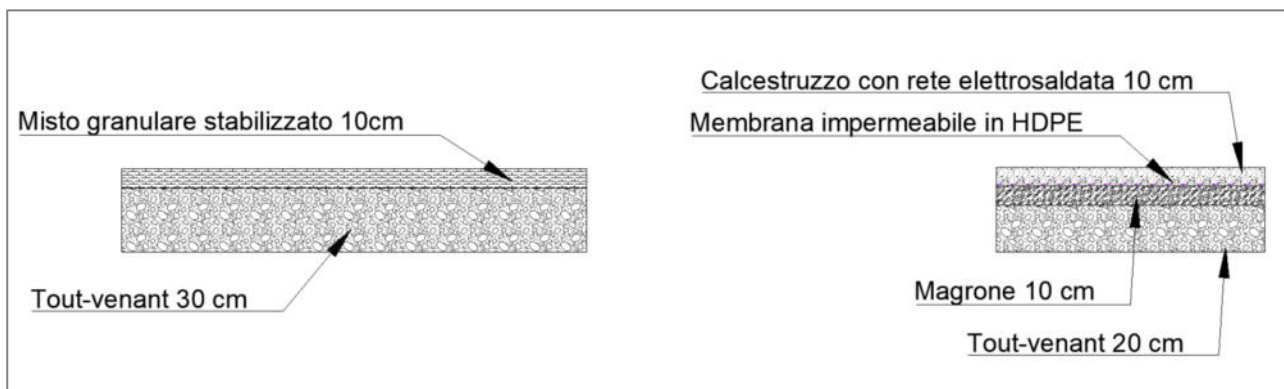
Sezioni trasversali dei pacchetti planimetrici con indicazione degli apprestamenti di cantiere
